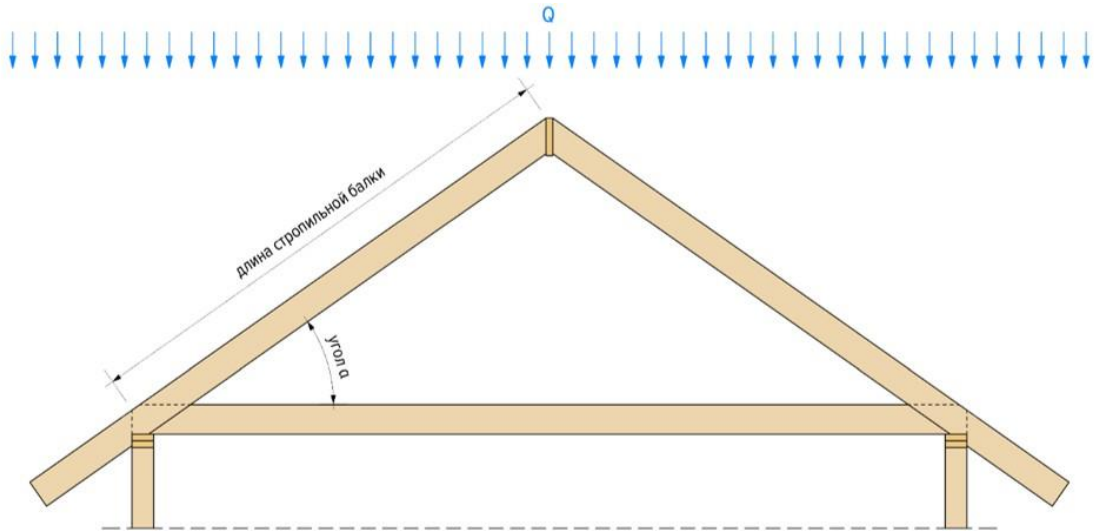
Расчётная схема стропил с затяжкой
